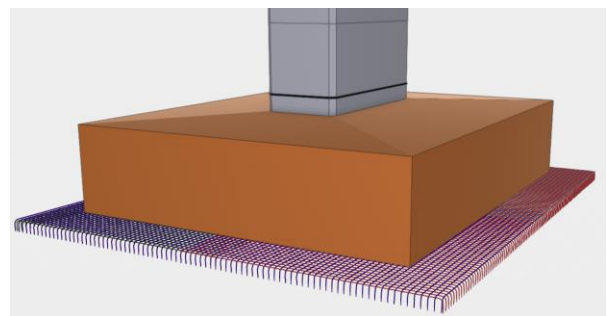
Pendiente para favorecer el drenaje en la cara superior de las zapatas y armado de hormigón de limpieza.
